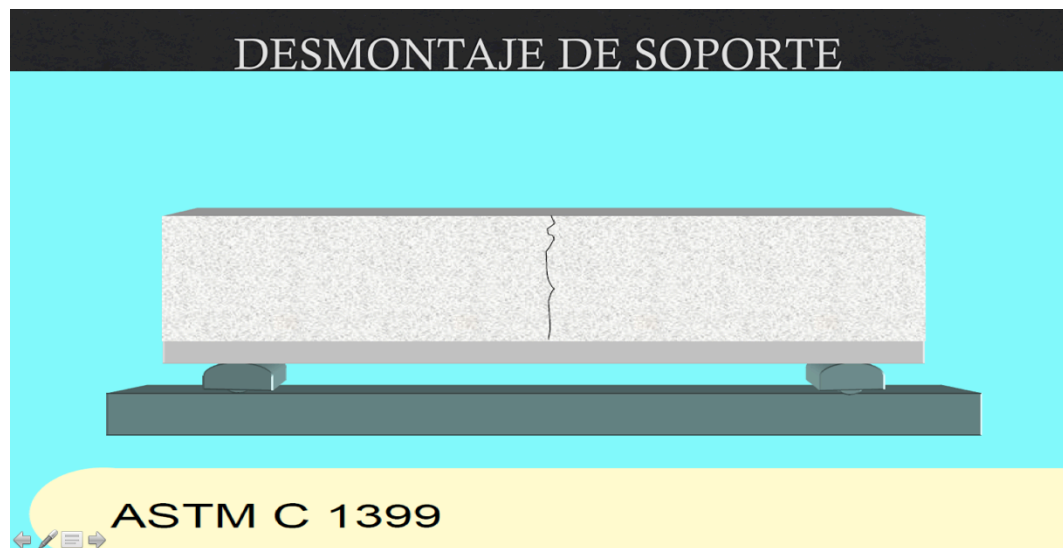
Esquema de retirado de deformímetros sobre viga de concreto.<sup>48</sup>
